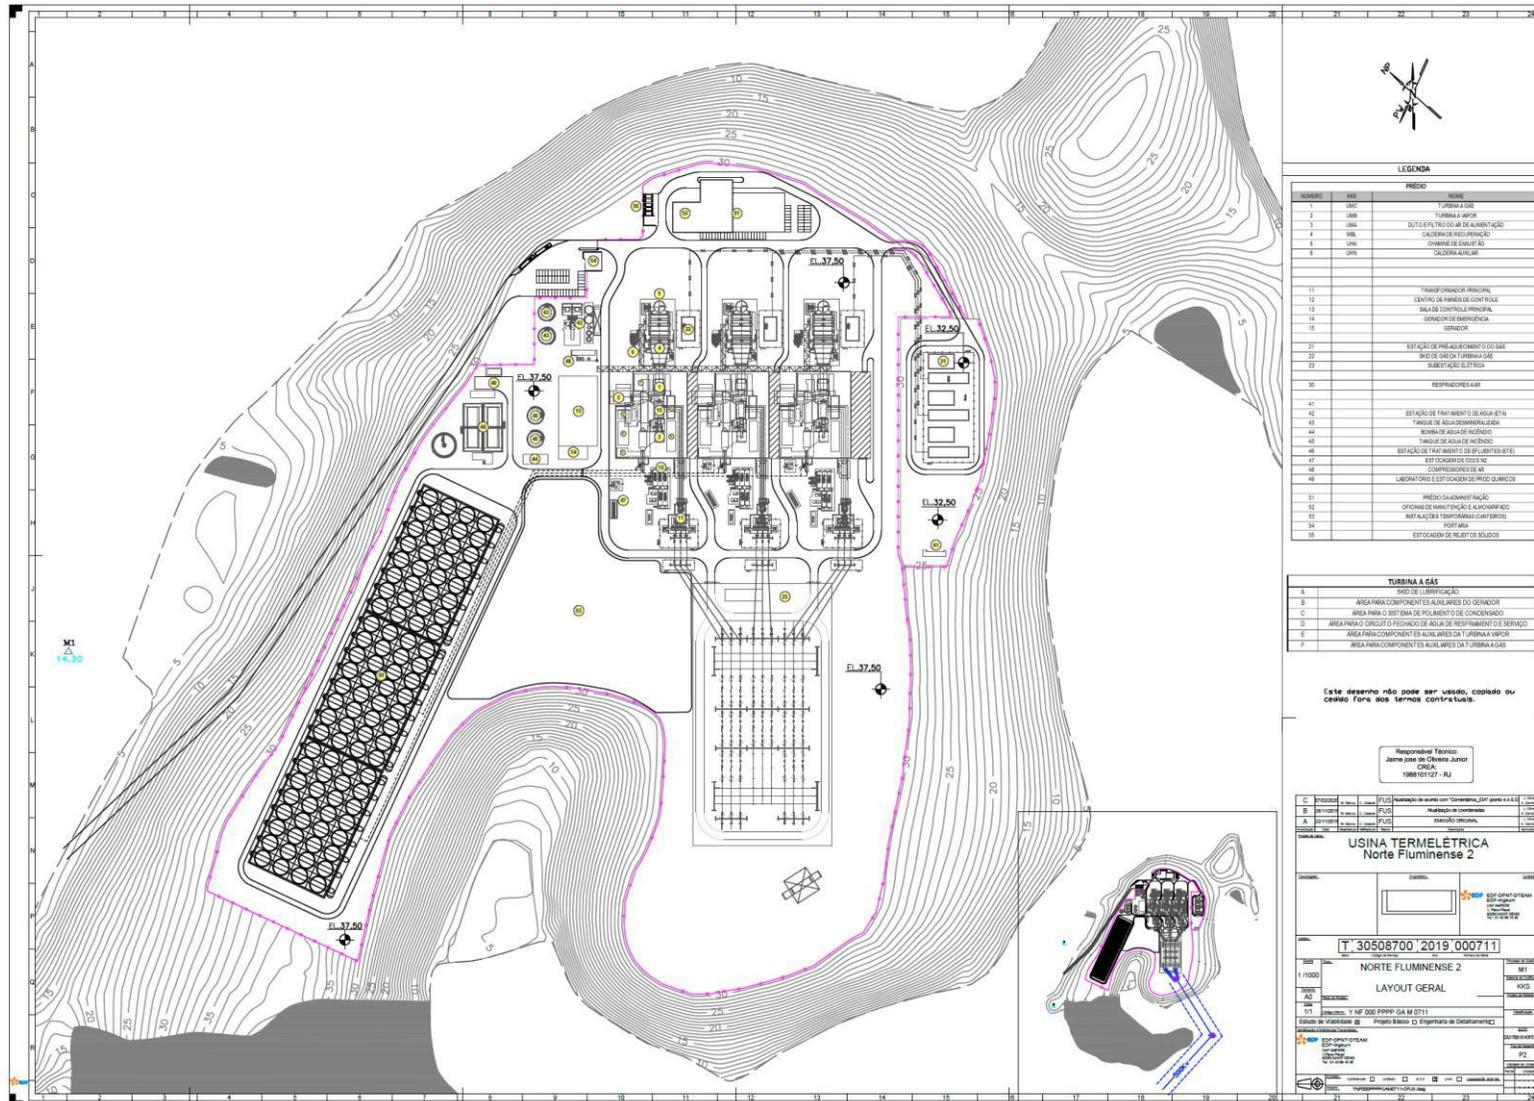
LAYOUT GERAL (PARA MELHOR VISUALIZAÇÃO VER ANEXO 3.5.2-1)
